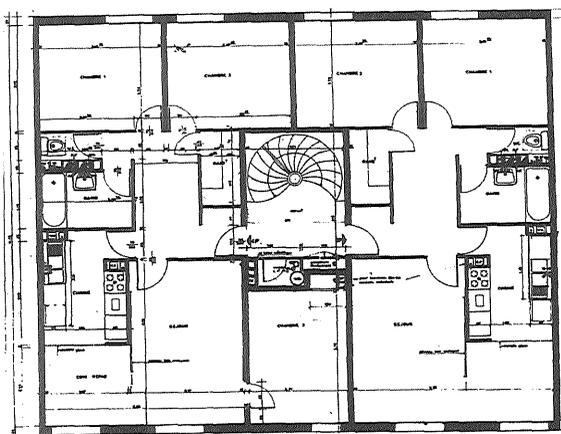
Plantas, baja y primera, de los bloques ortogonales de viviendas.
